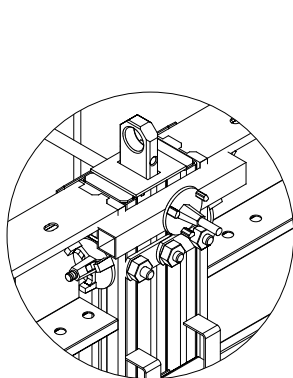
Szalunek zmontowany – beton w szalunku
